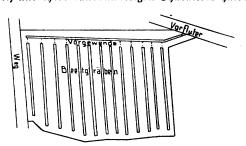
Lageplan einer Rimgauschen Moorbammfultur.
